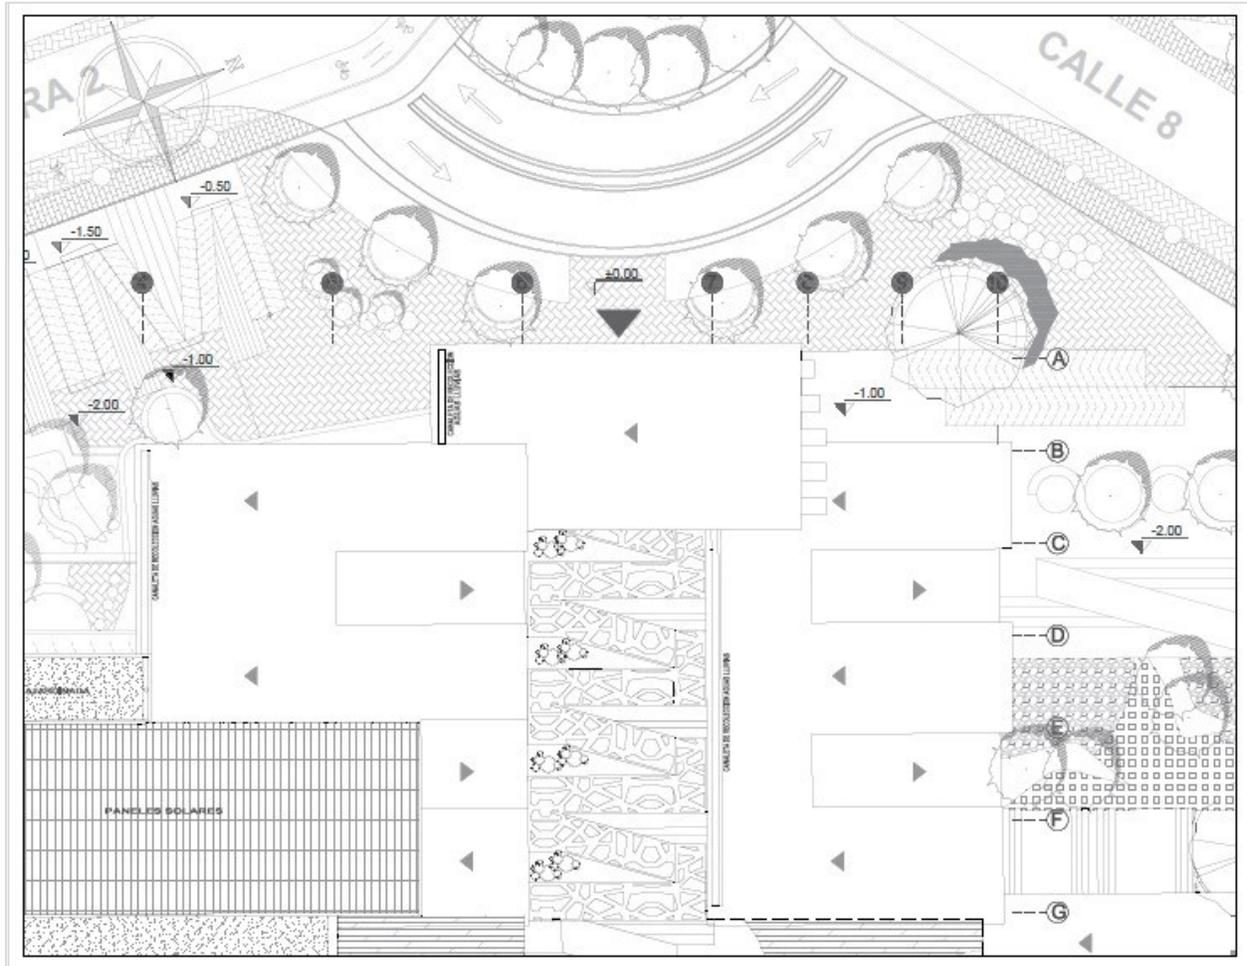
Cubierta Edificación 1 (Rubiano, 2020)
